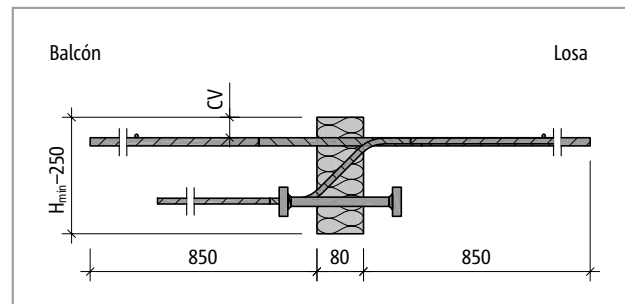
Schöck Isokorb® T tipo K-M12 en R0: Sección del producto
